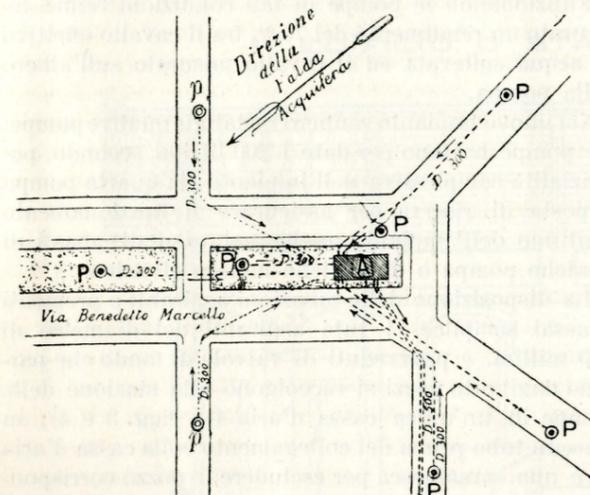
Planimetria dei pozzi e della stazione di pompe.
